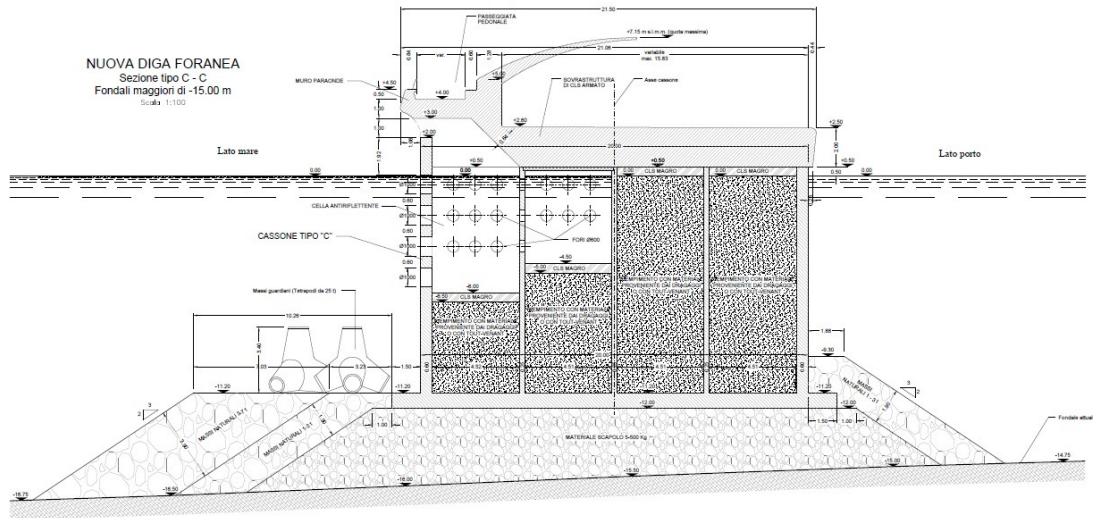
Sezione tipo della diga foranea per fondali maggiori di 15,00 m
